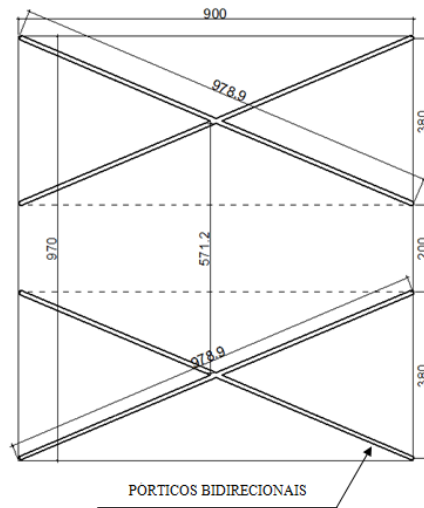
Planta do sistema estrutural com pórticos de estabilização.
